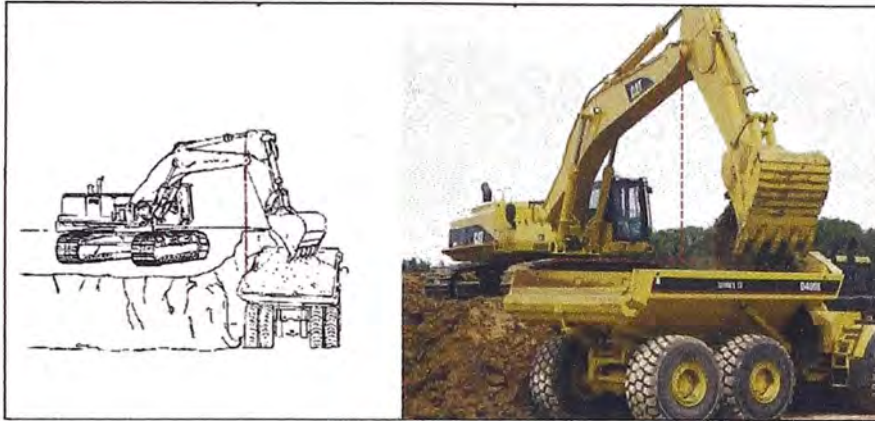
Posición ideal del equipo de acarreo durante el carguío
